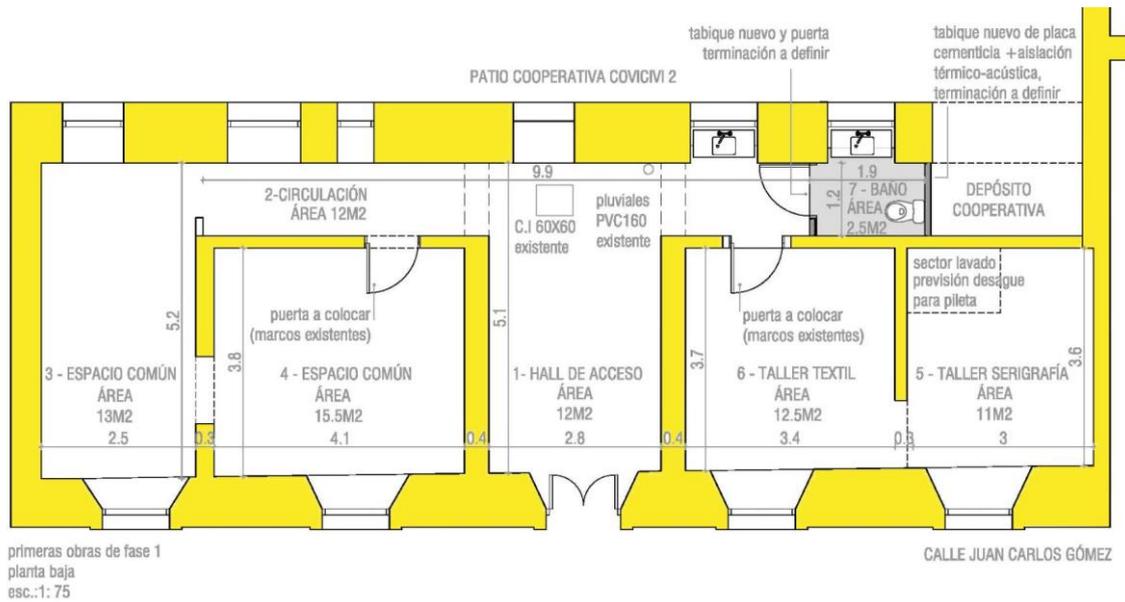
Planta baja anteproyecto de fase 1. Fuente: Elaboración propia.
